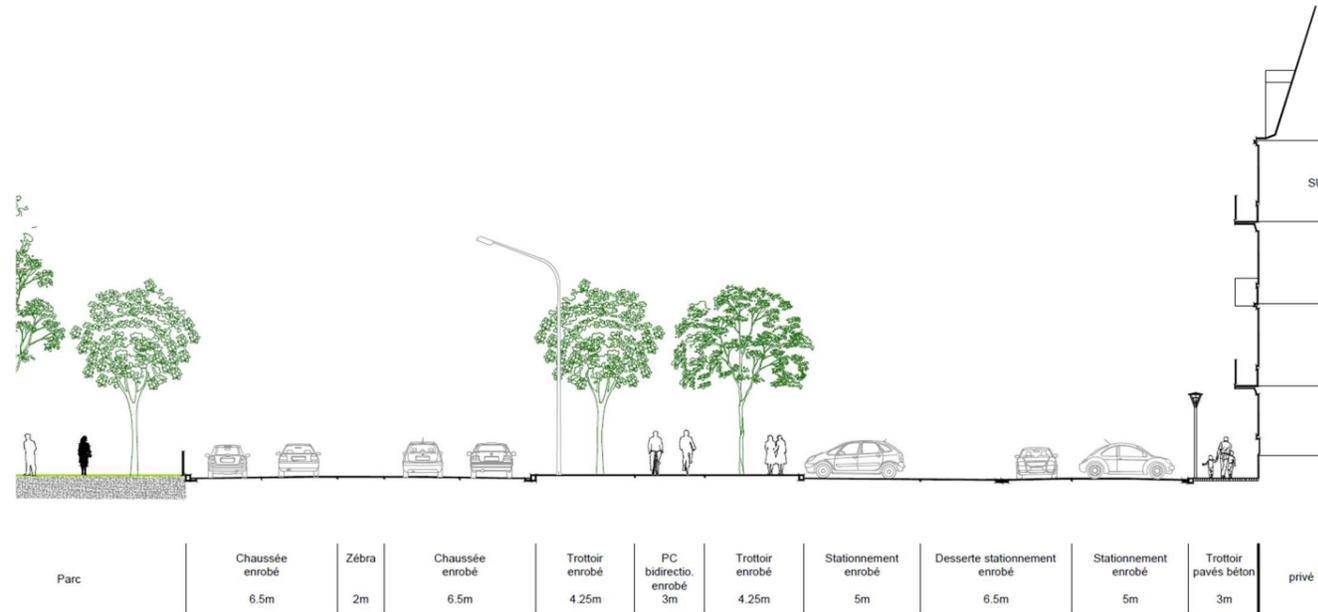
Plan de la place de Haguenau (source : AVP GETAS, 2023)
